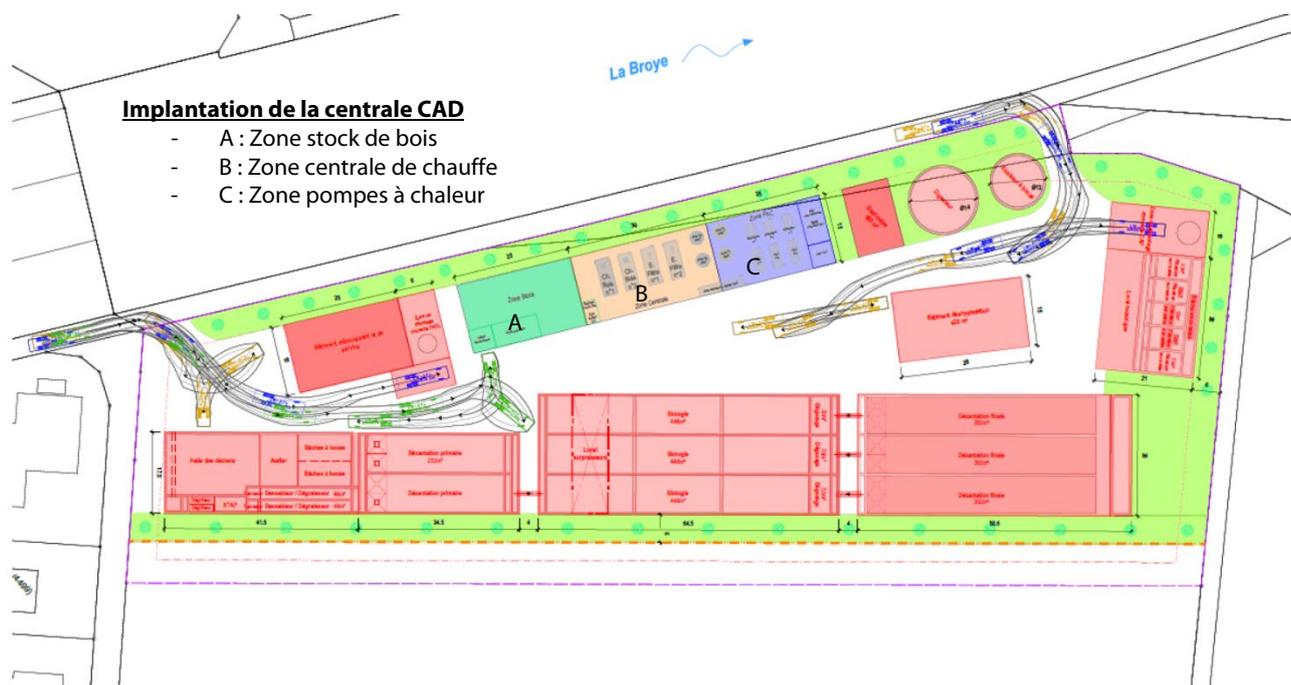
Implantation de la centrale de chauffe sur le site de la future STEP de l'Épaise
